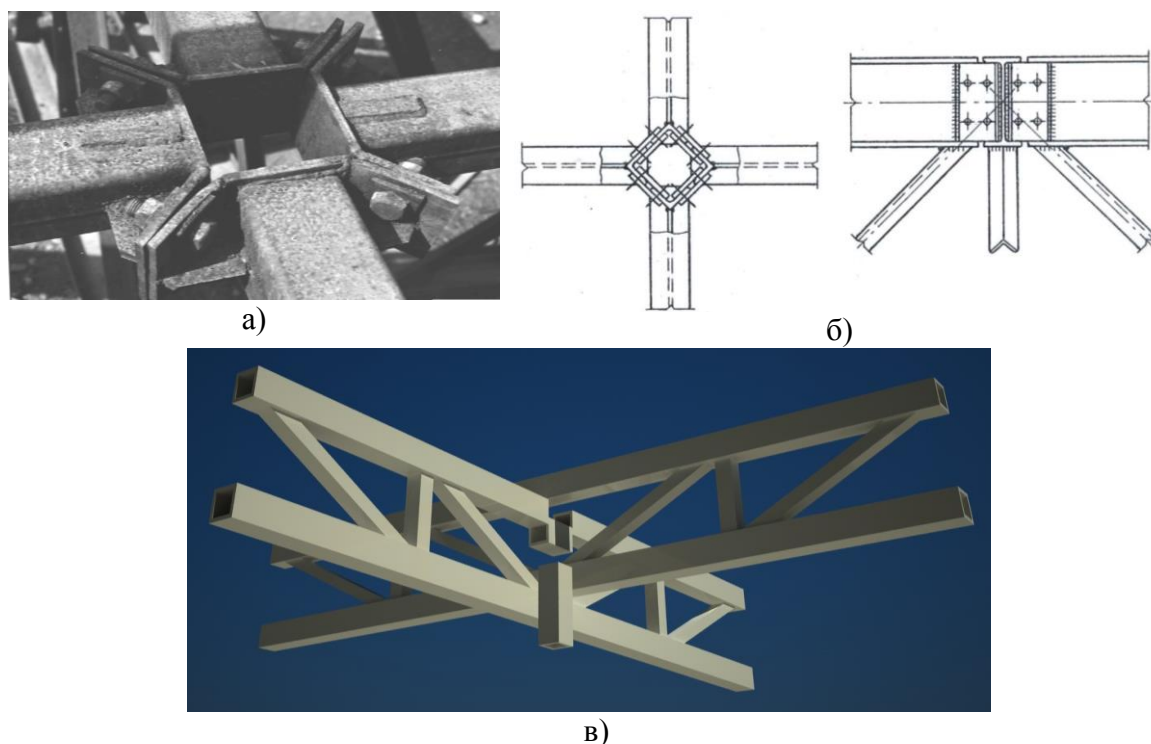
Снимок монтажного соединения перекрестных стальных ферм из трубчатых профилей на гнутых фланцах с диафрагмами жесткости (а) и схема монтажного соединения перекрестных стальных ферм из прокатных профилей на листовых накладках с уголковыми фасонками (б), а также общий вид перекрестных ферм типа «Пятигорск» с монтажным окном в верхнем (сжатом) поясе (в)
